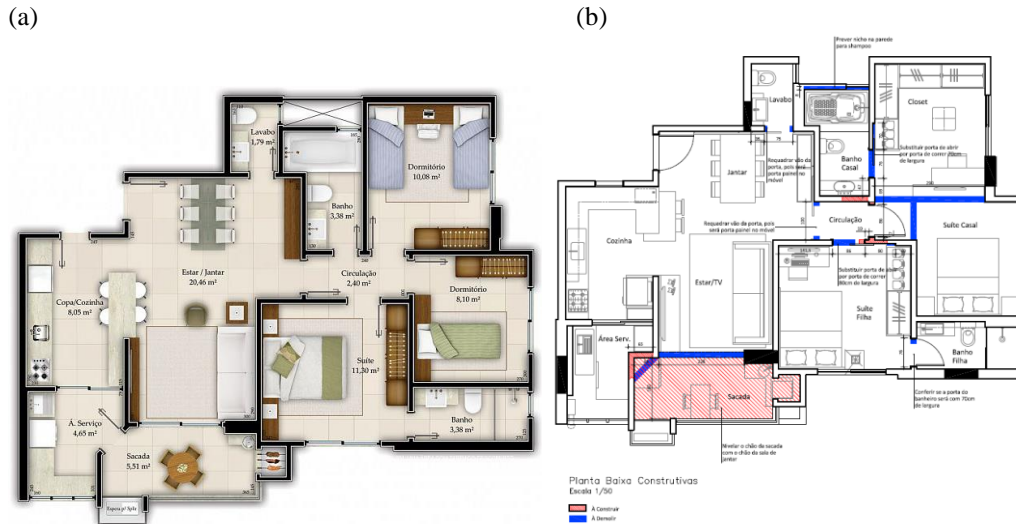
Projetos do empreendimento C. (a) Planta baixa de *layout* padrão. (b) Planta baixa com alterações de alvenaria (Fonte: acervo da construtora, 2019)
